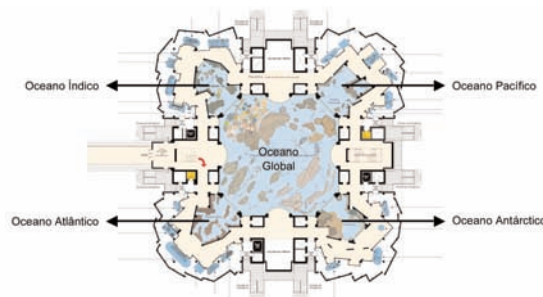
| Planta do piso inferior - nível 8.4 metros.
